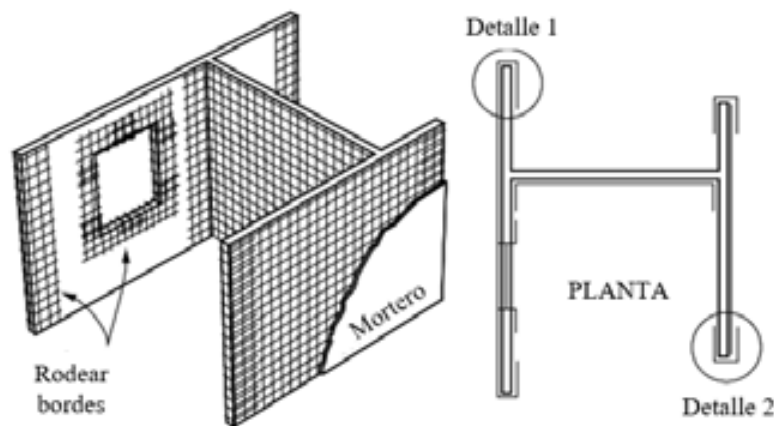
Disposiciones normativas para la colocación de malla de alambre en la superficie de los muros de mampostería (NTC-Mampostería, 2017)
